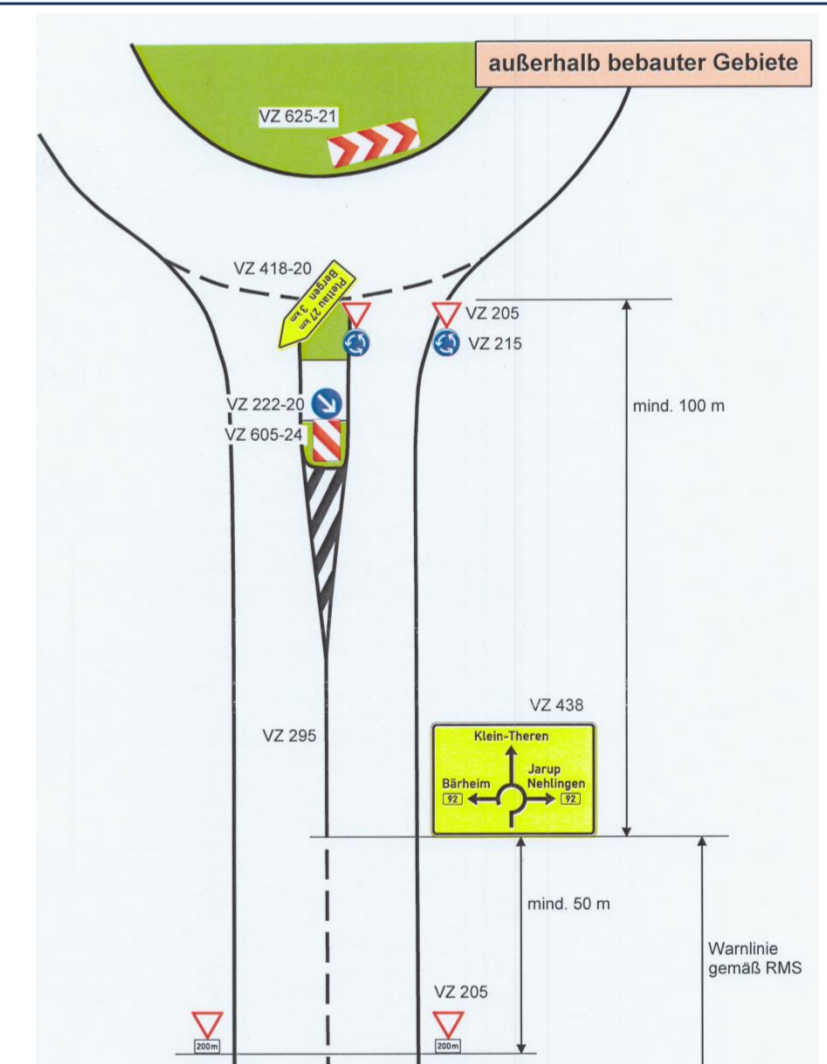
Musterbeschilderungsplan außerhalb bebauter Gebiete
